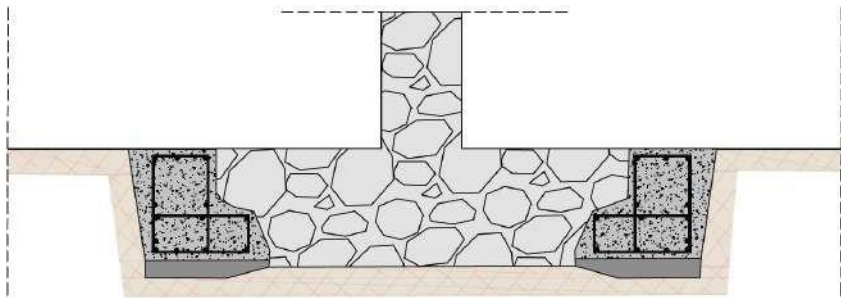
Sección zapata aislada. Refuerzo Tipo 3. Fuente propia
